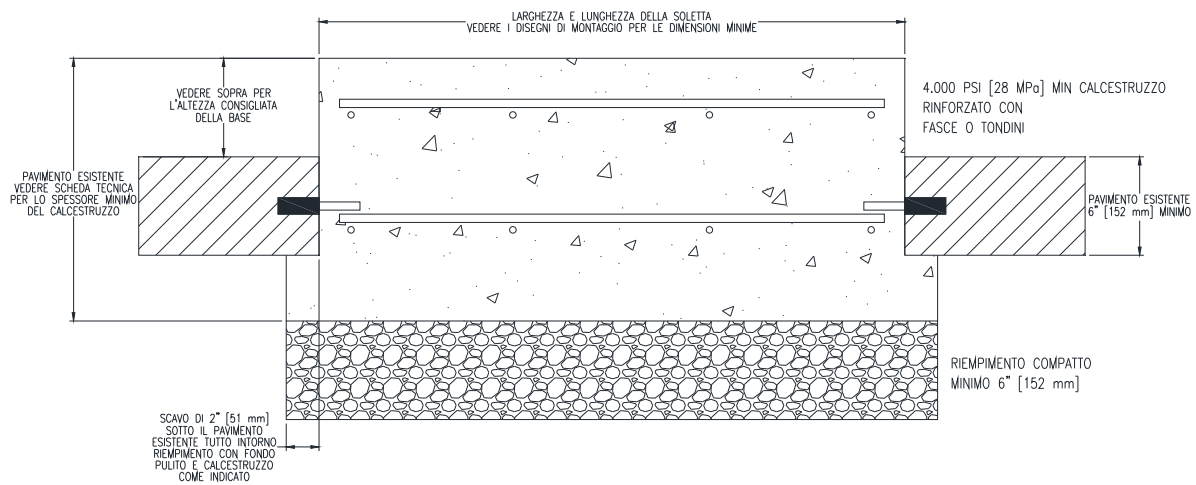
Nuova base rialzata in calcestruzzo fissata al pavimento esistente
